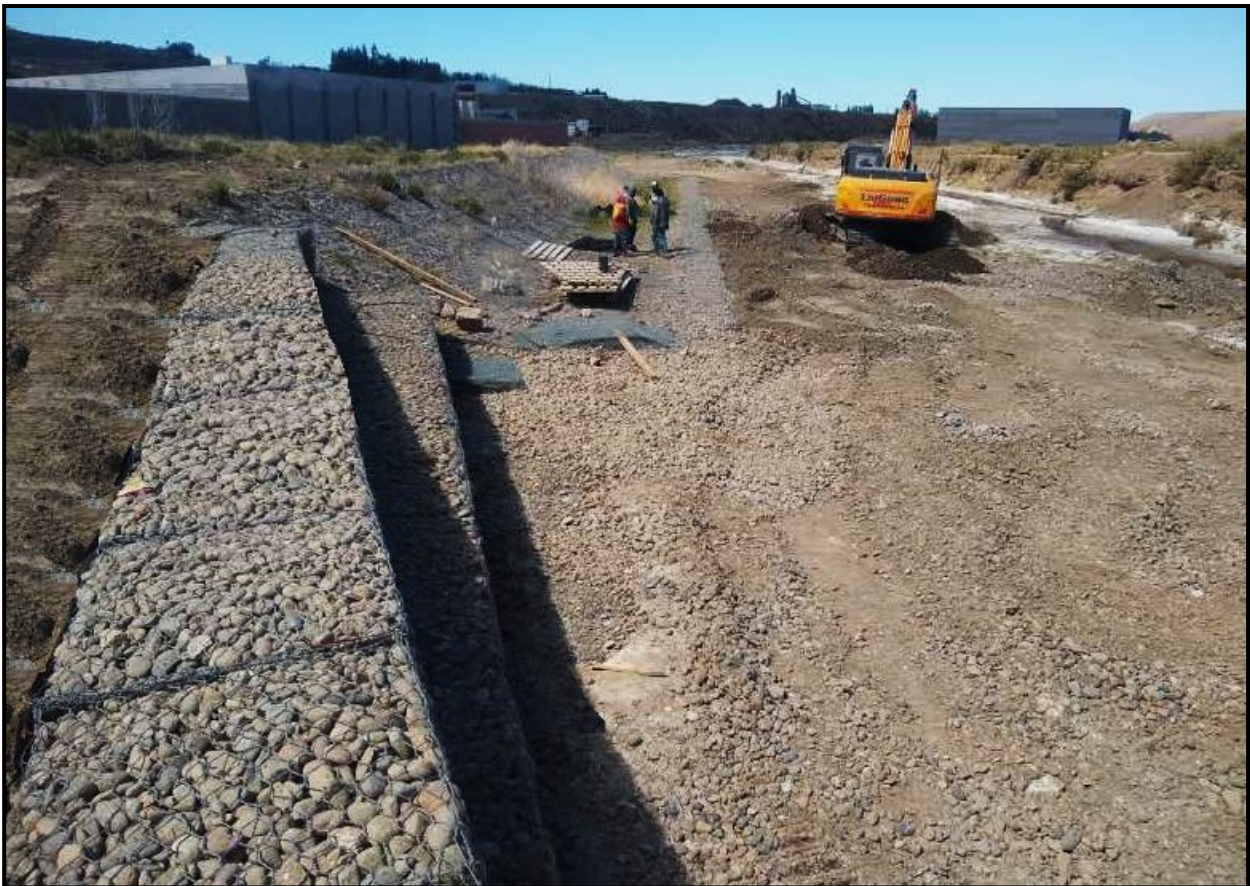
Zona de encuentro entre primera y tercera etapa. Vista aguas abajo.
